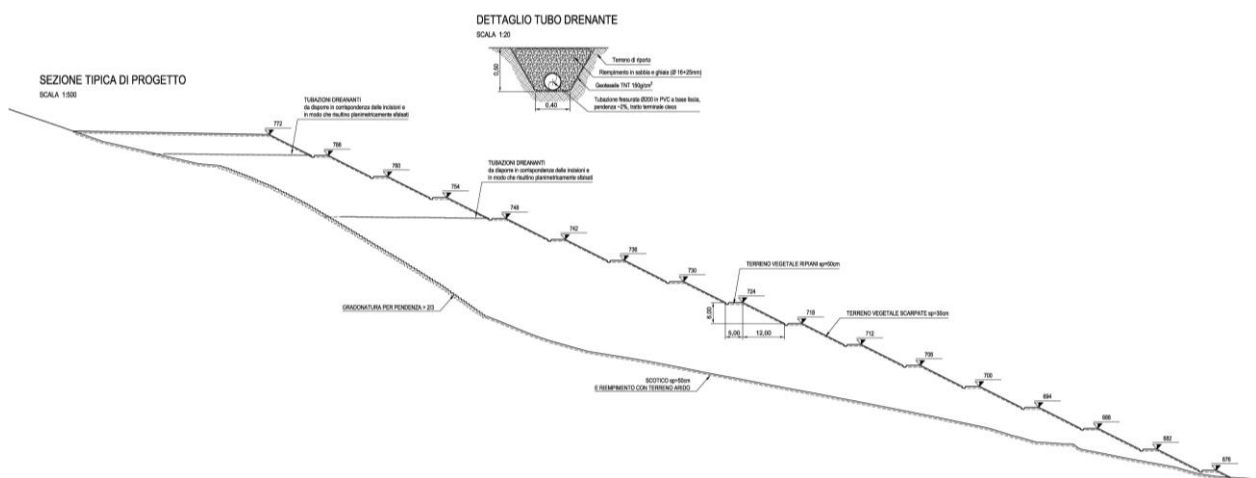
Sezione tipo di progetto di ripristino cava a versante
